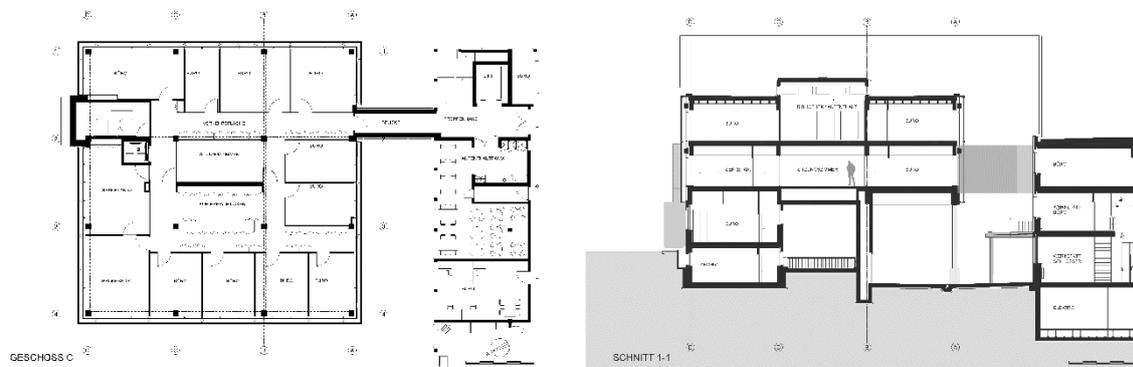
Grundriss C und Schnitt durch das ETH House of Natural Resources (mml Architekten)
